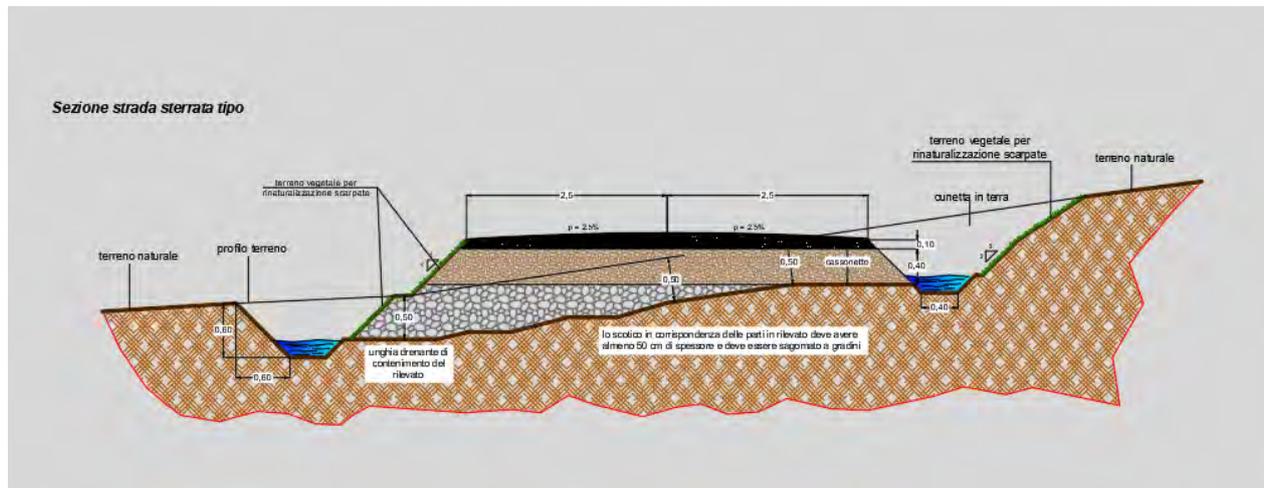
Sezione stradale tipo (Rif. Elaborato E.04)
